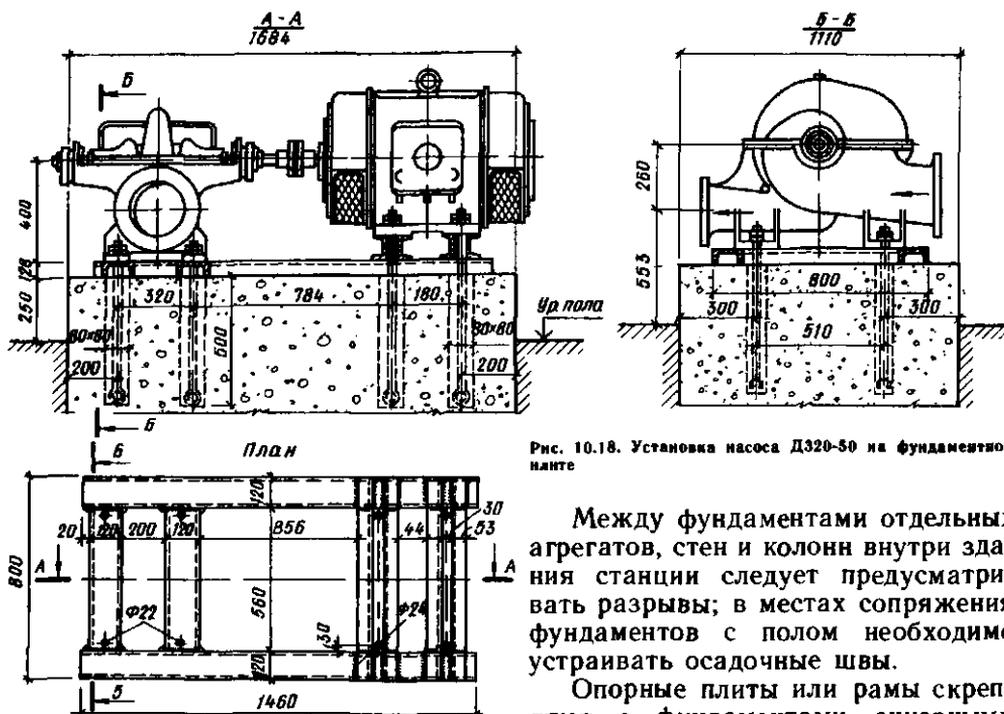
Установка насоса Д320-50 на фундаментной плите
